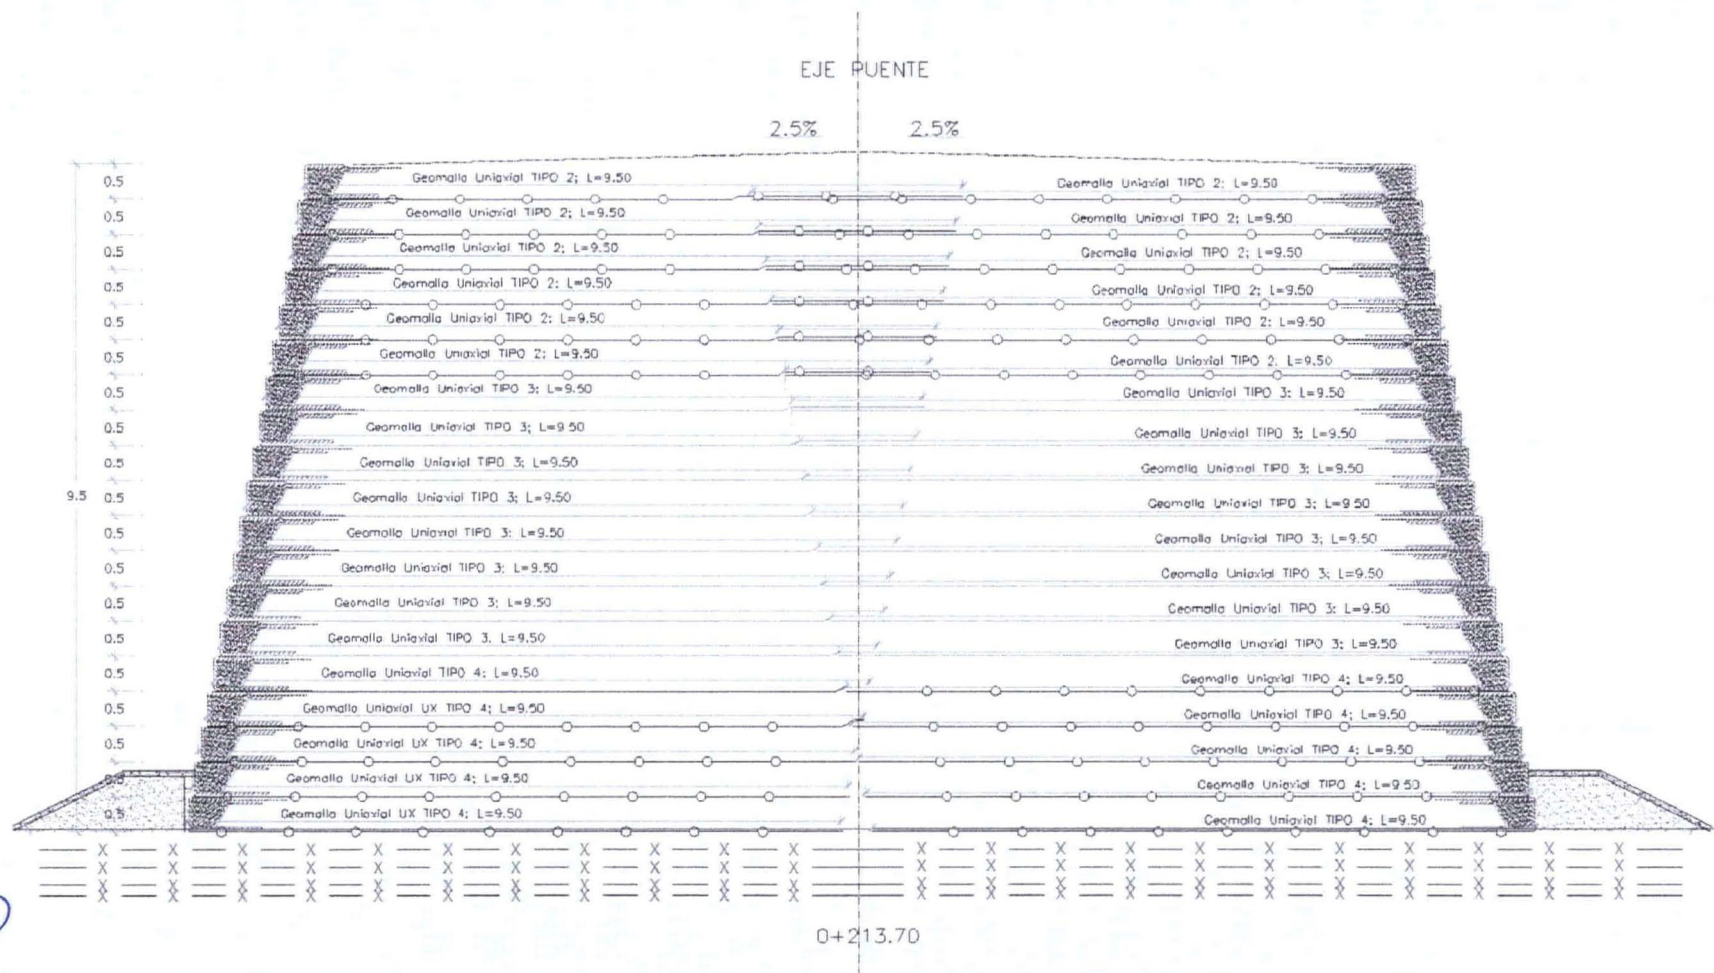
RAMPA DE ACCESO MARGEN DERECHA: Muro de Suelo Mecánicamente Estabilizado, Av. La Marina - Estribo 1.
